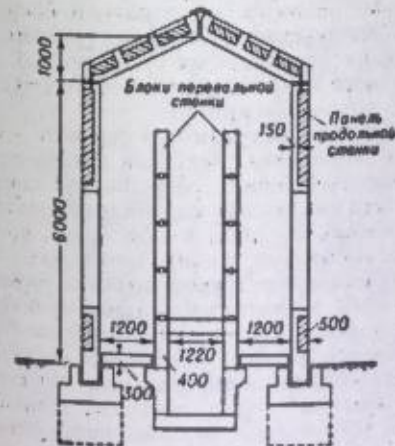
Поперечный разрез беспламенной печи с панельными горелками из сборных панелей.
